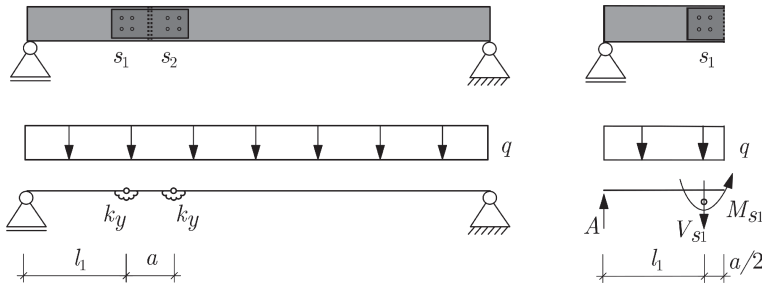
Biegebeanspruchter Balkenstoß.
